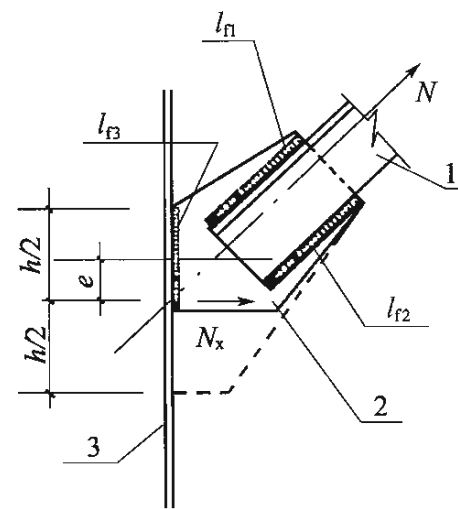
节点板焊缝的偏心示意图
